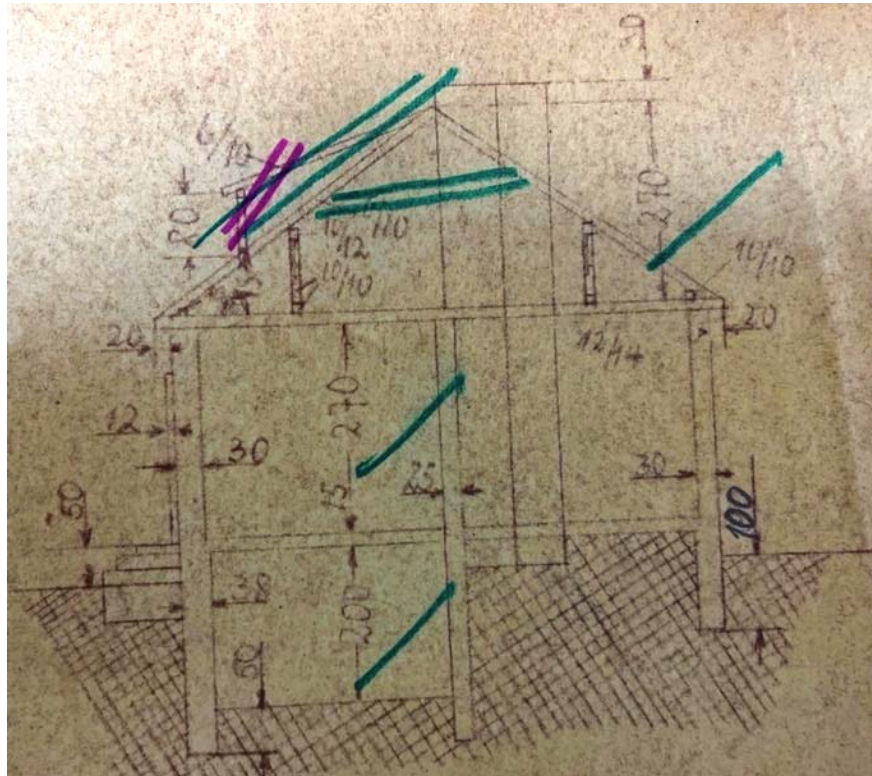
bauzeitlicher Plan – Schnitt durch das Einfamilienhaus
